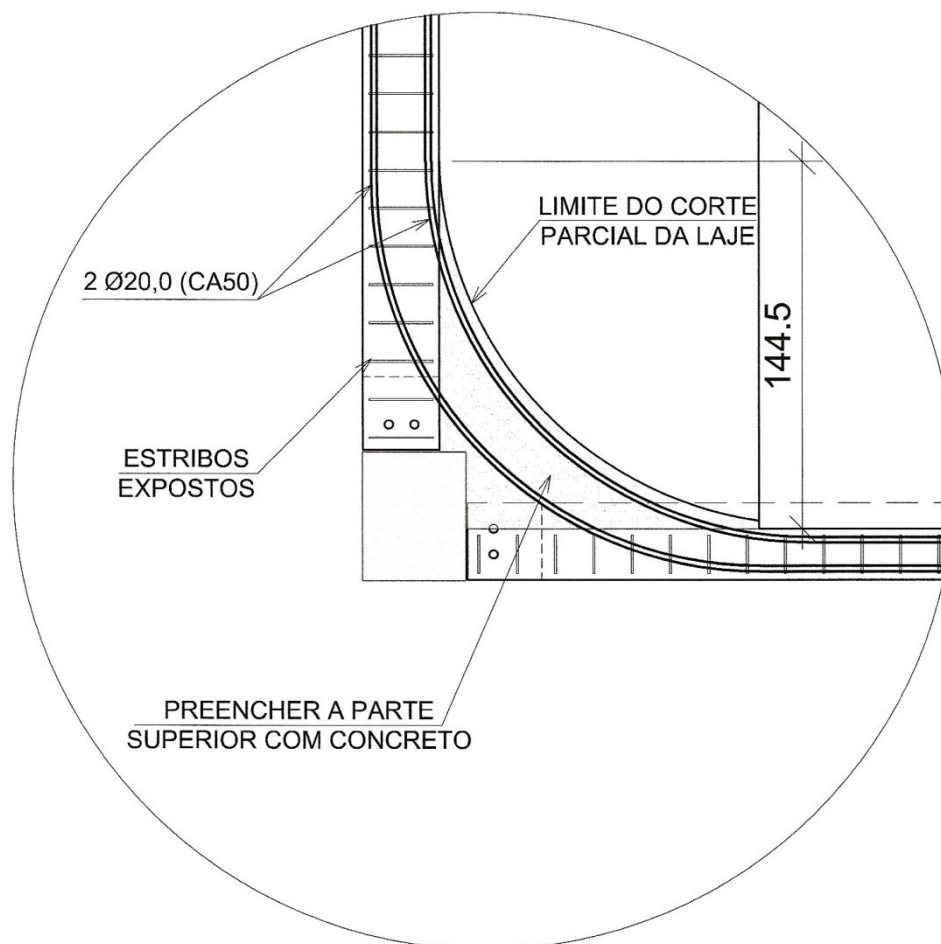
16 – Vista em planta da ancoragem dos tirantes na região extrema da estrutura (pilares de canto).
